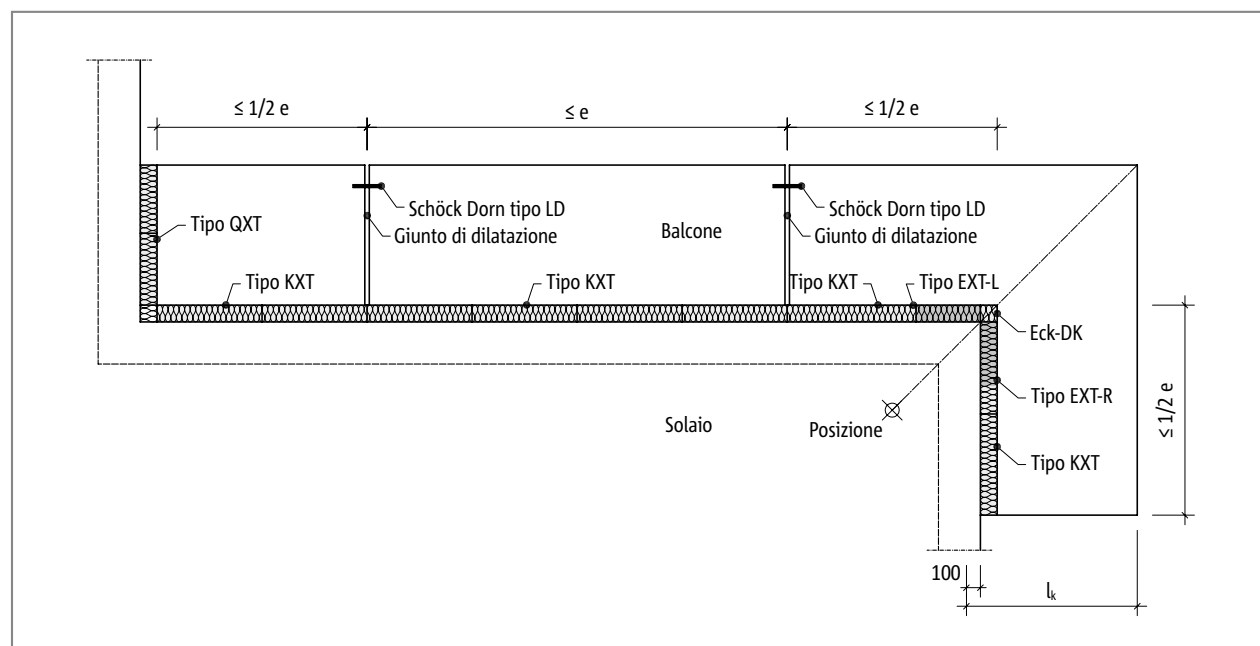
Schöck Isokorb® tipo EXT: disposizione dei giunti di dilatazione
